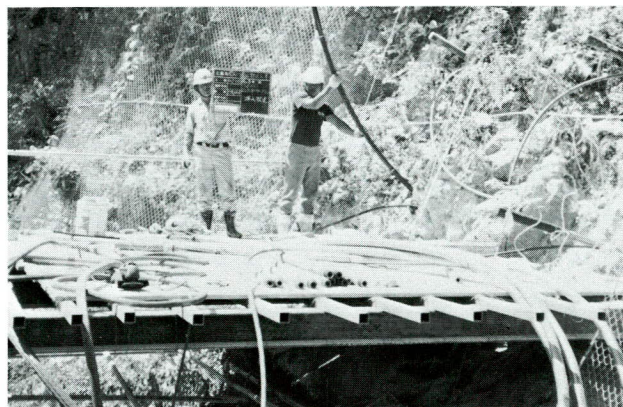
引張材(SEE)ストランド・ケーブルの挿入状況
